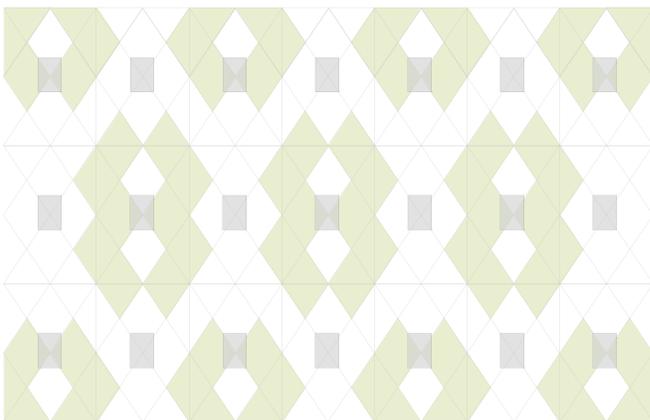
Trama 3 de locales y adaptación alrededor de cimentación existente.
